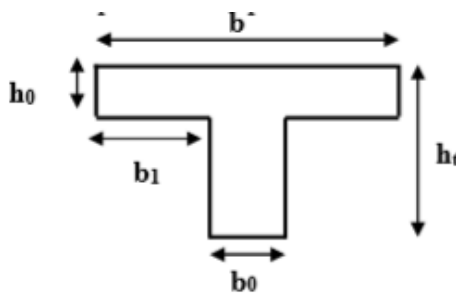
Schéma de calcul d'un plancher à corps creux
